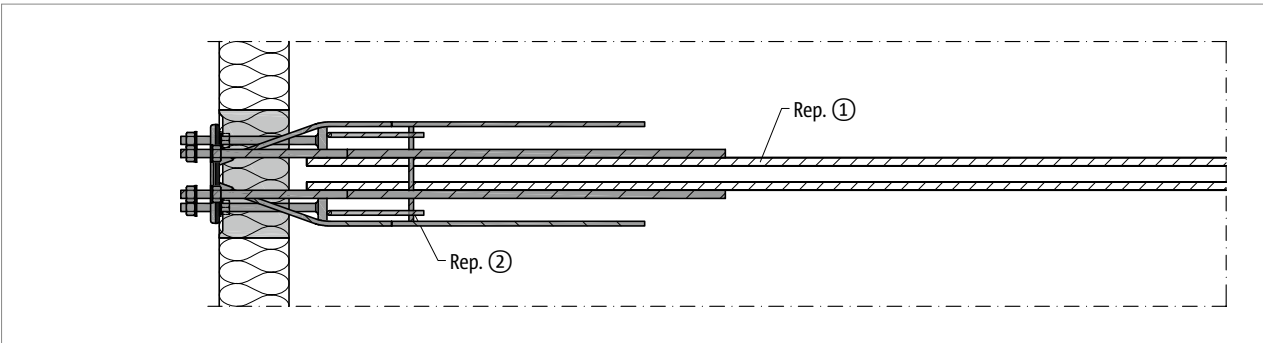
Schöck Isokorb® XT type SK-M1 : armatures à prévoir par le client, vue en plan
